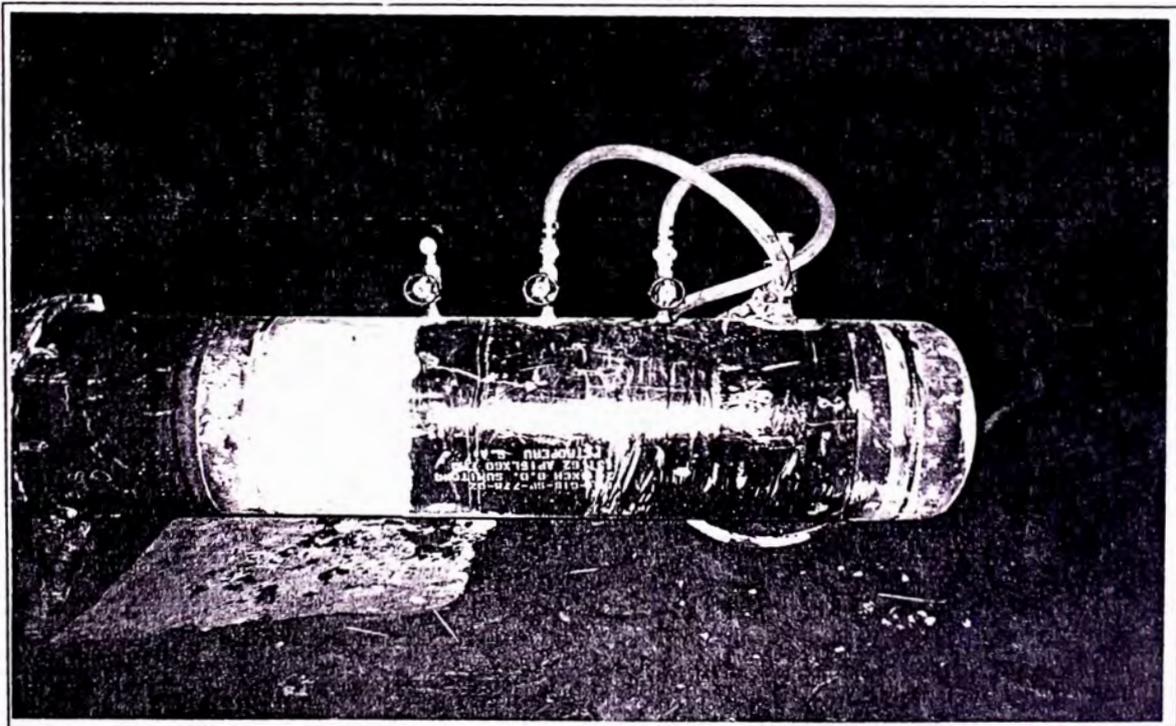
Inyección de aire comprimido al Varillón por intermedio de dos mangueras. El Pig y el Poy-Pig avanzan.
